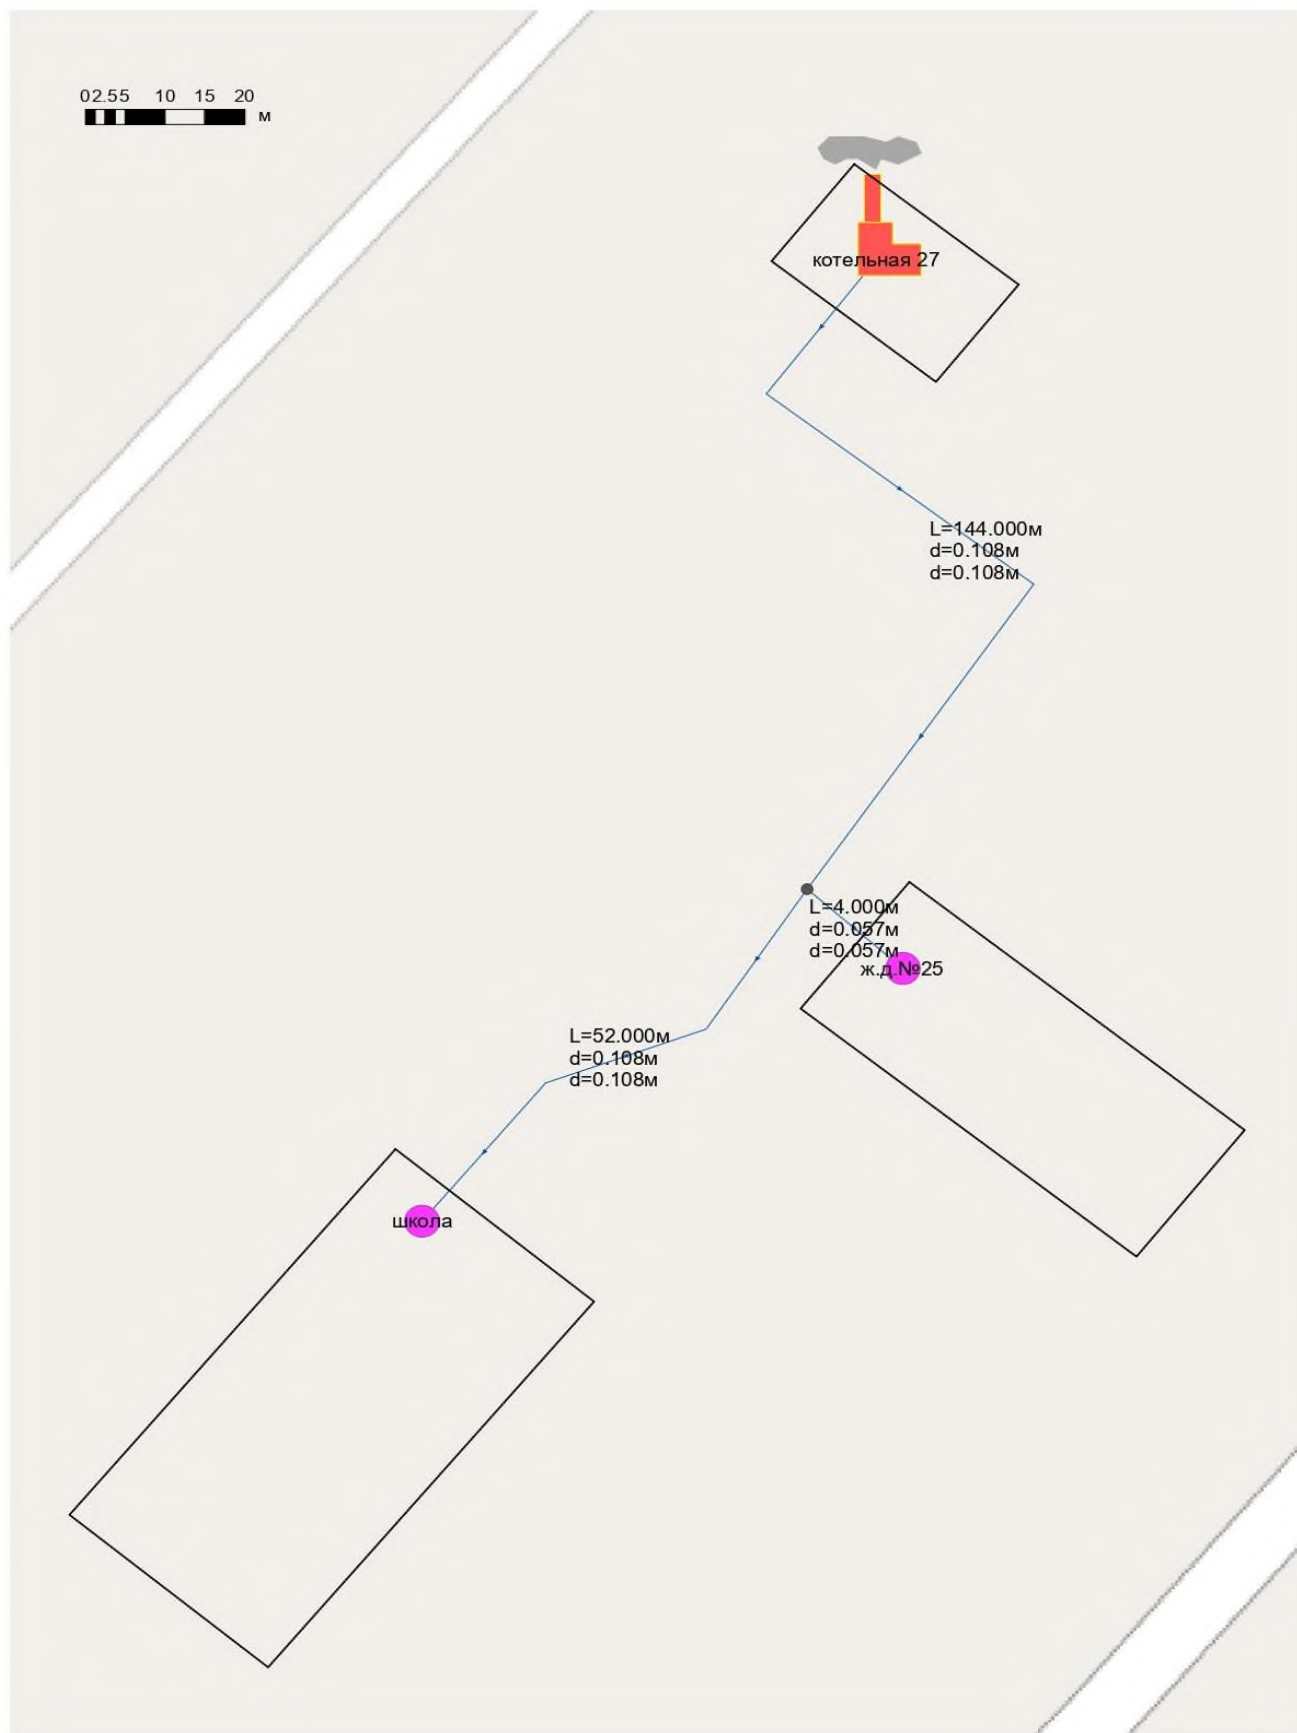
Схема теплоснабжения котельной АМК №1/27
